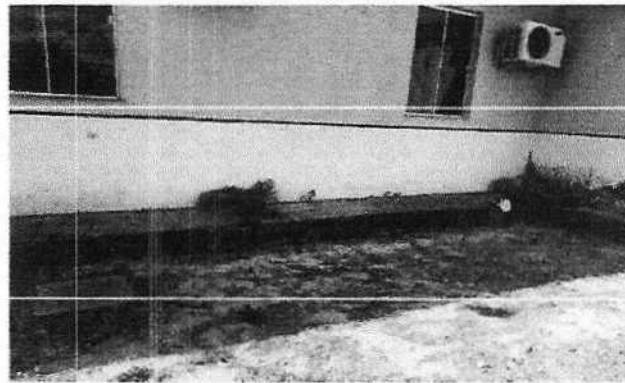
Calçada externa a ser demolida e refeita em função da elevada quantidade de fissuras
